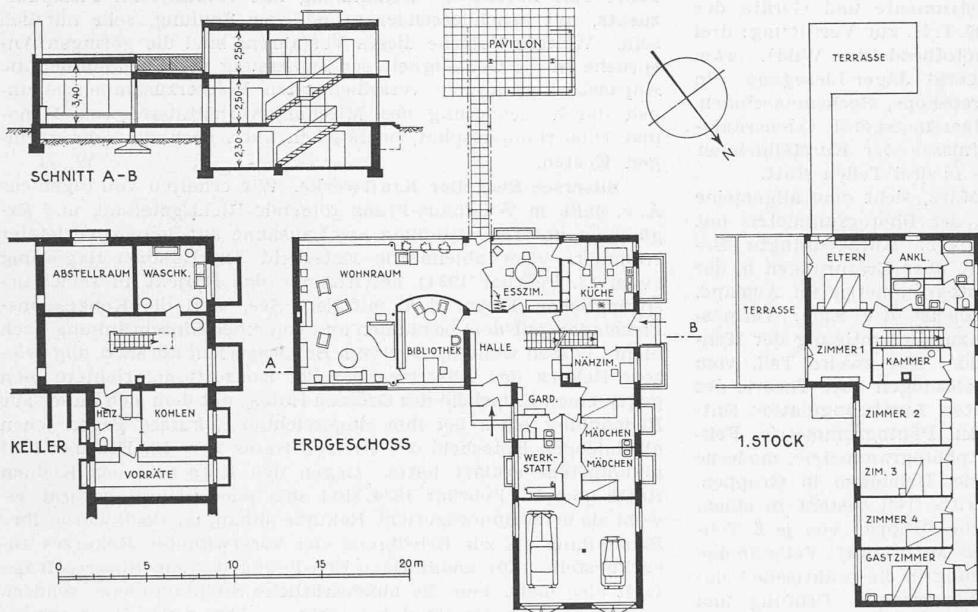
Grundrisse und Schnitte des Hauses am Schnitterweg in Riehen. — 1 : 400.
